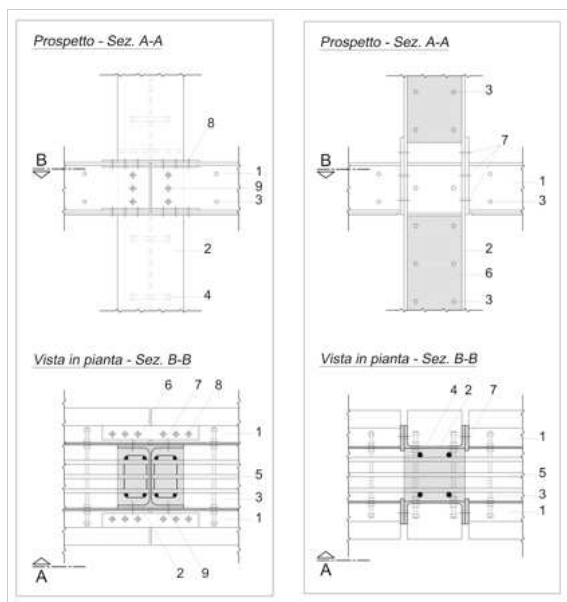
Sezione tipica di un pilastro HC (Hybrid Column)
